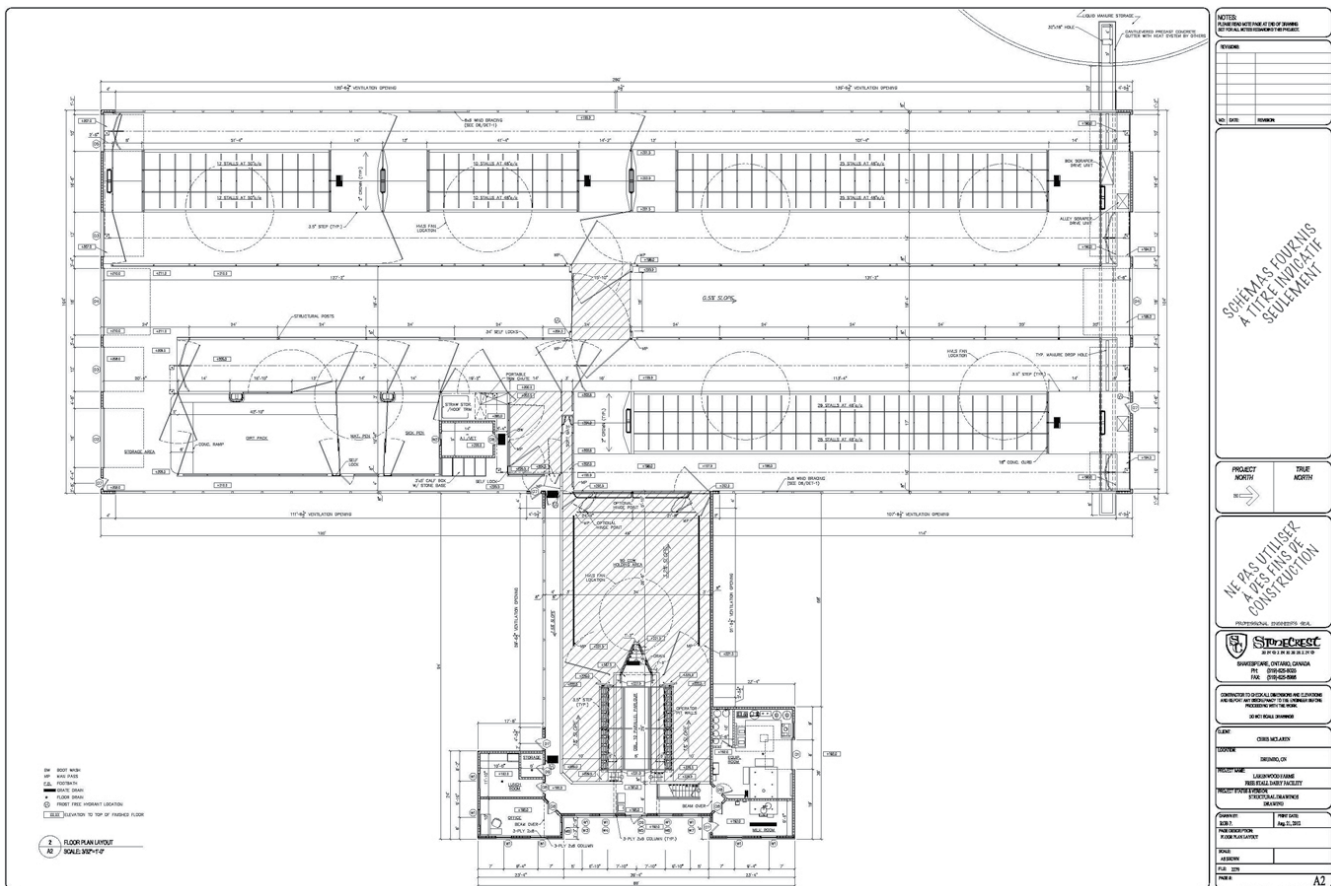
Exemple d'un plan de plancher d'une étable à stabulation libre.
